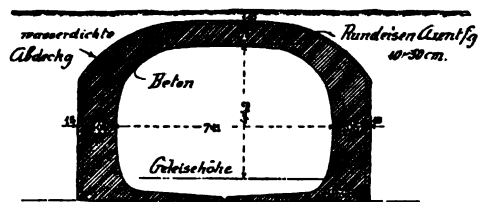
Querschnitt des flach überwölbten Einschnittes unter der Summer-Street.
